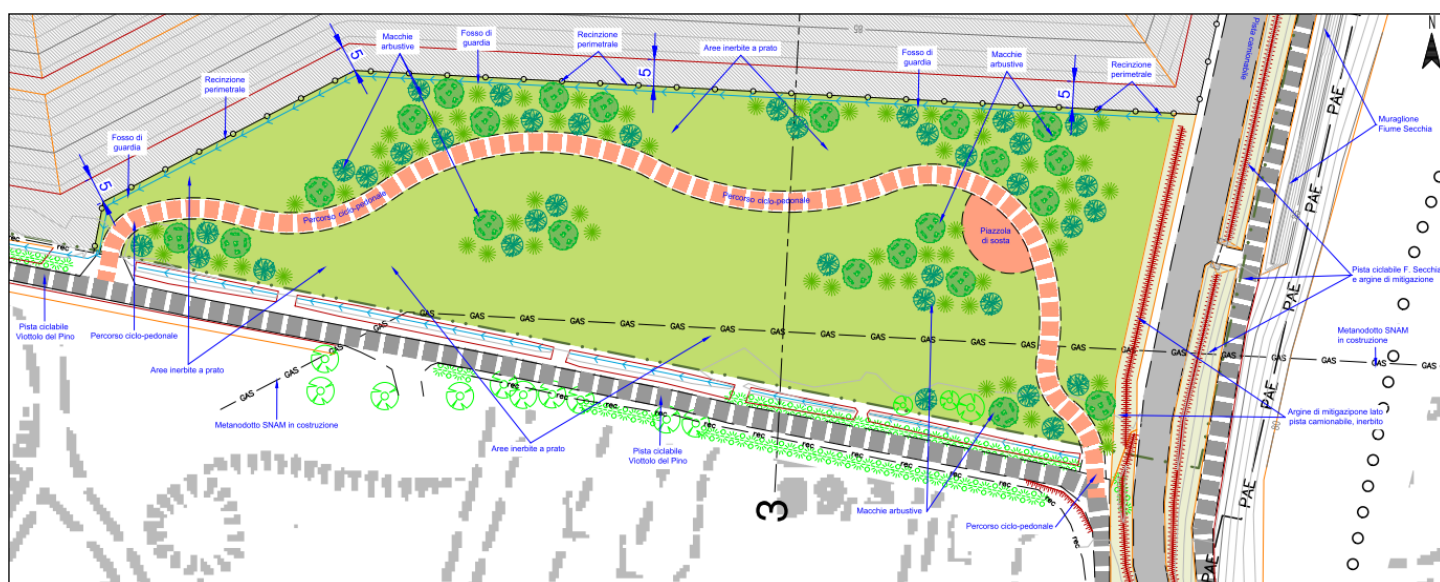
Stralcio Tav. 09 - Progetto "Sistemazione finale delle aree e destinazioni d'uso". Dettaglio della porzione sottesa alle fasce di rispetto dell'infrastruttura SNAM e a recupero di tipo naturalistico, con allestimento vegetazionale e realizzazione di pista ciclabile e area di sosta.
